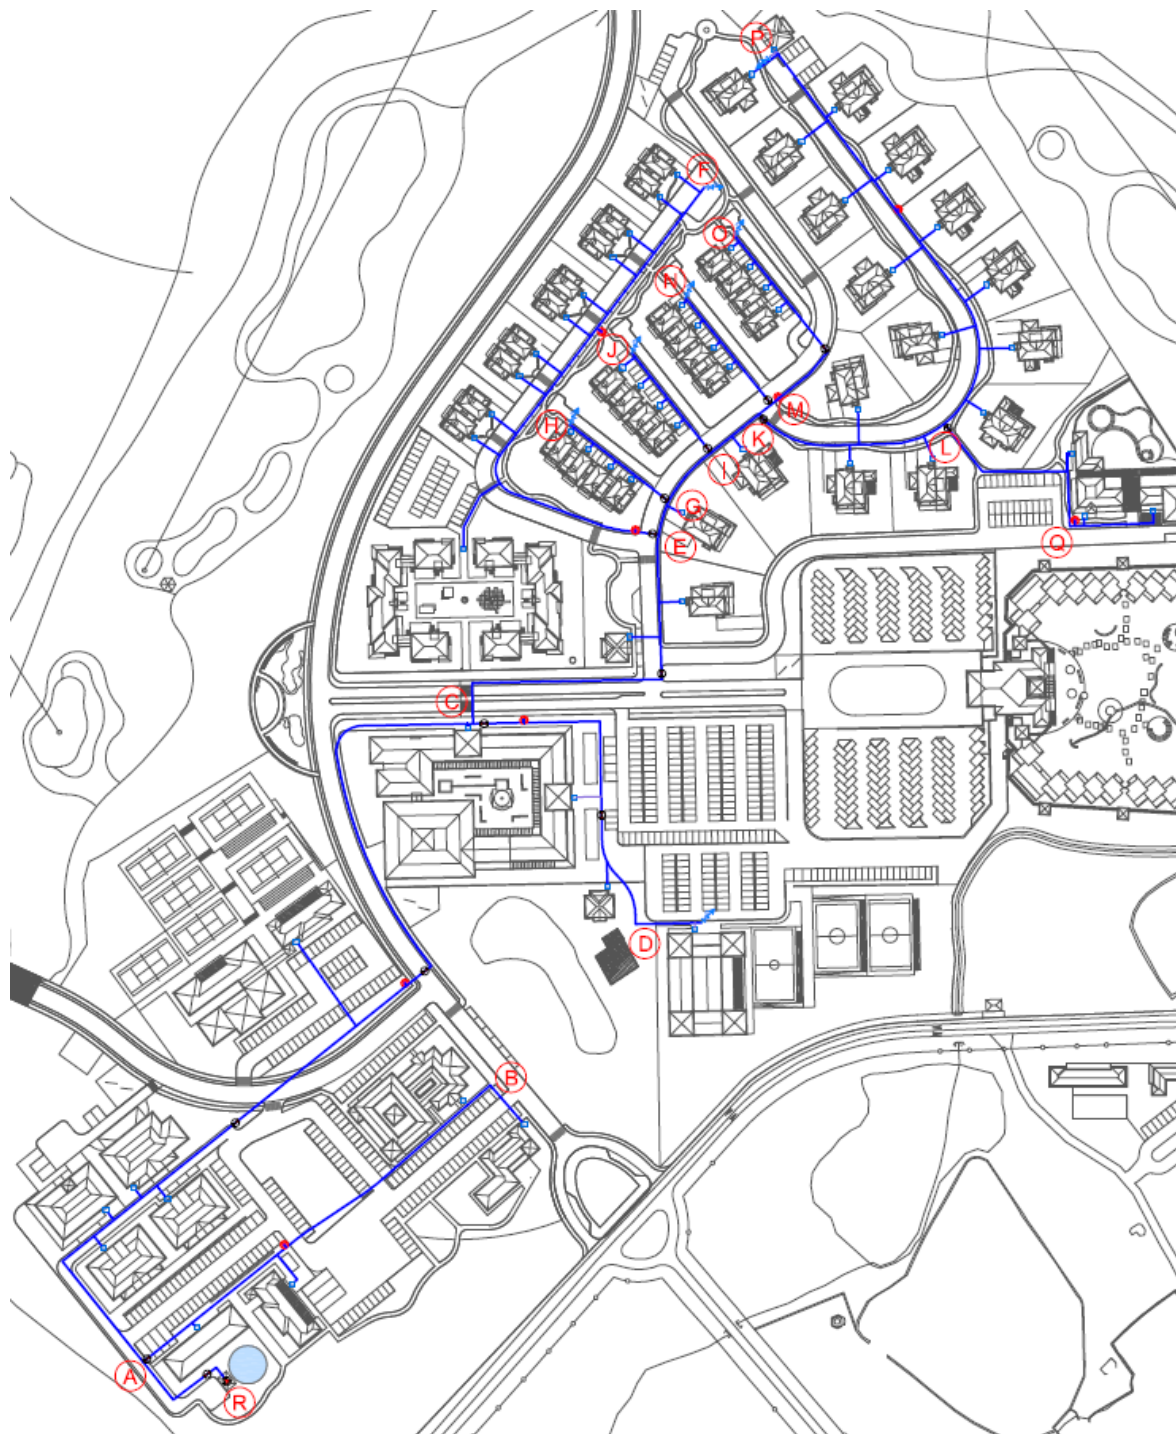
Traçado da rede de distribuição ramificada em planta (aldeamento 1).
